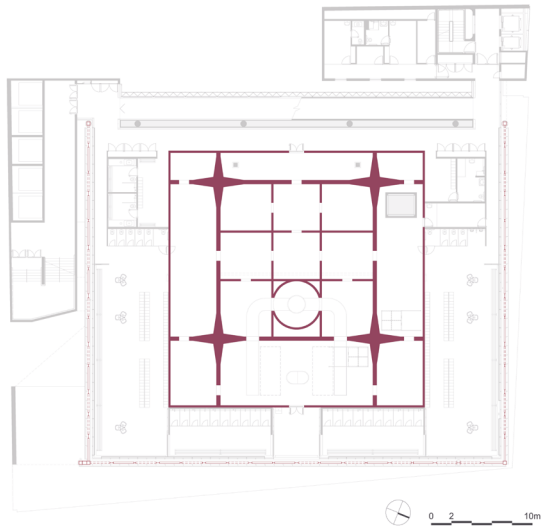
Vigas de la estructura de la piscina y la estructura metálica de los vestuarios. (Autoría propia, 2022).
